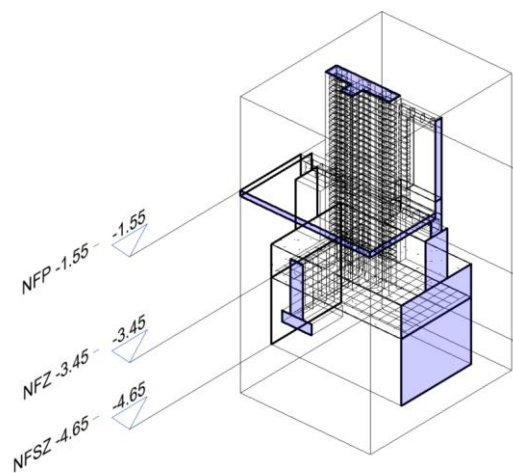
Detalle de encuentro de placa con viga de sobrecimiento, zapata y viga de cimentación.
